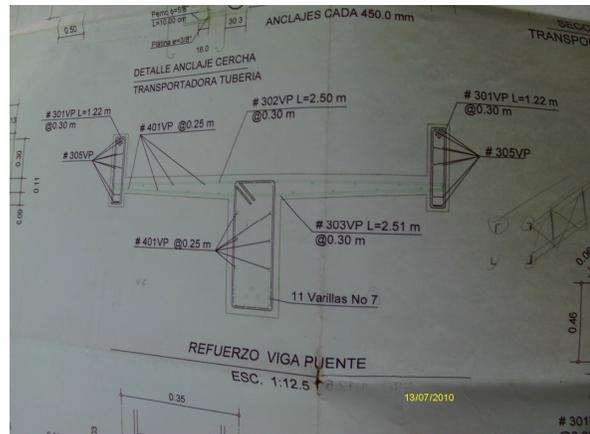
Detalle de refuerzo en planos de viga principal para puente peatonal.
